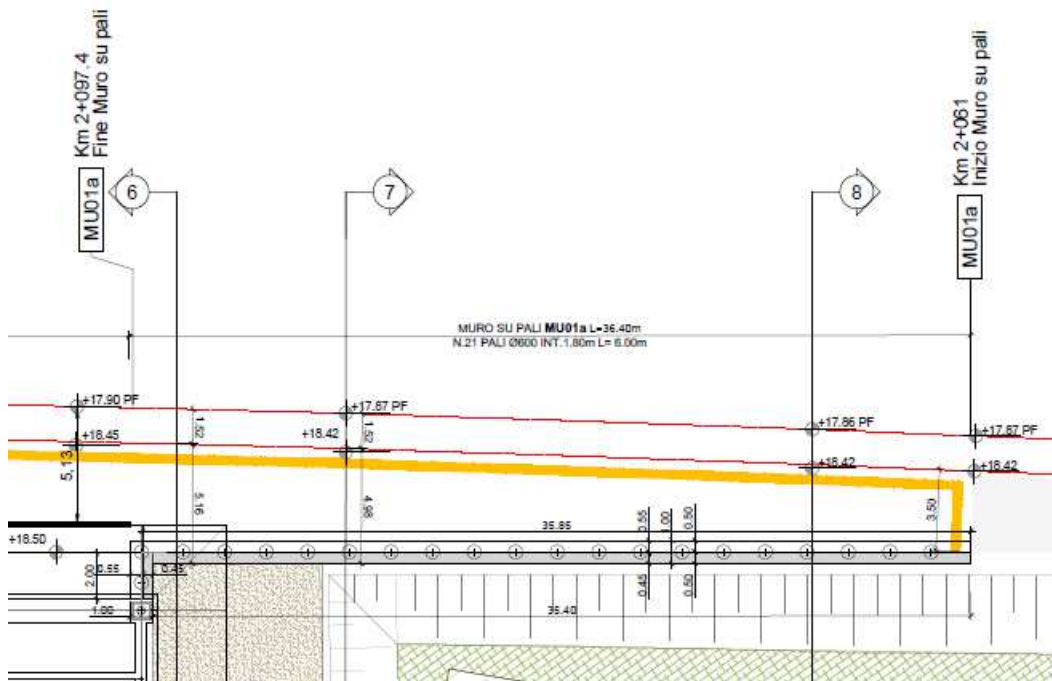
Muro di sostegno su pali – Pianta lato est del fabbricato.
